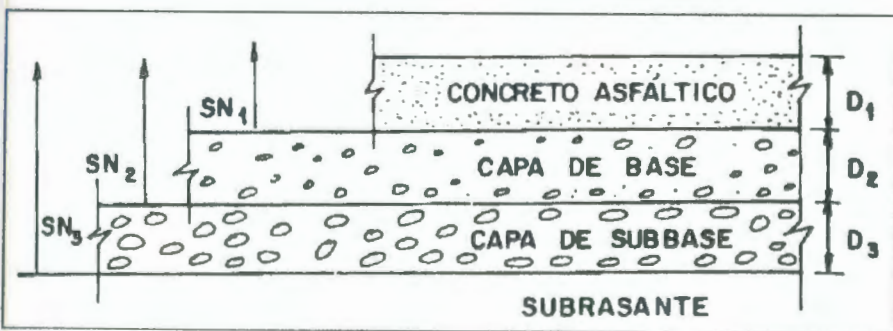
DETERMINACIÓN DE LOS ESPESORES DE LAS CAPAS DEL PAVIMENTO, AASHTO
